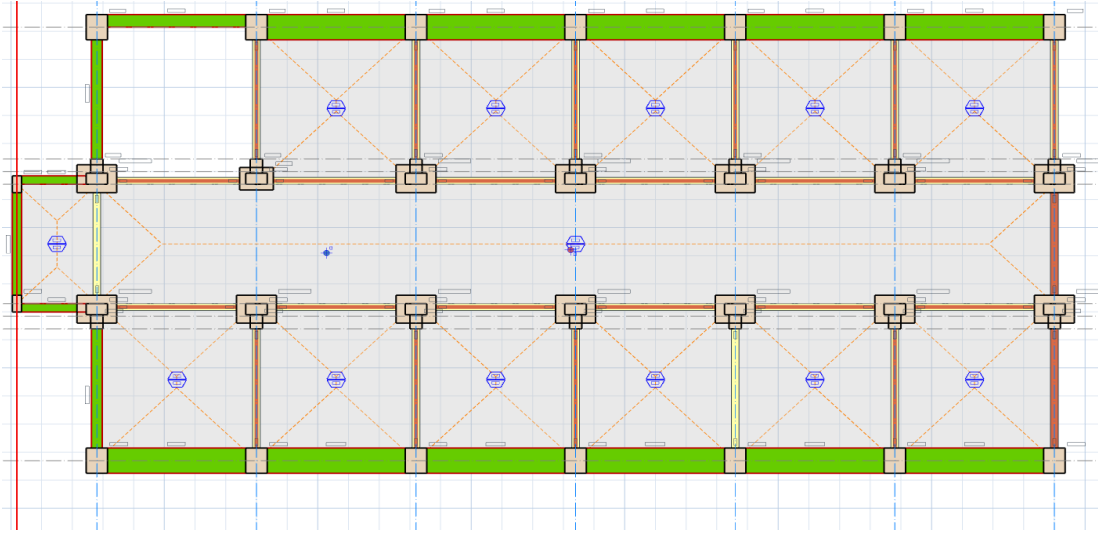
A blok 1. kısım 2. kat kat planı.
